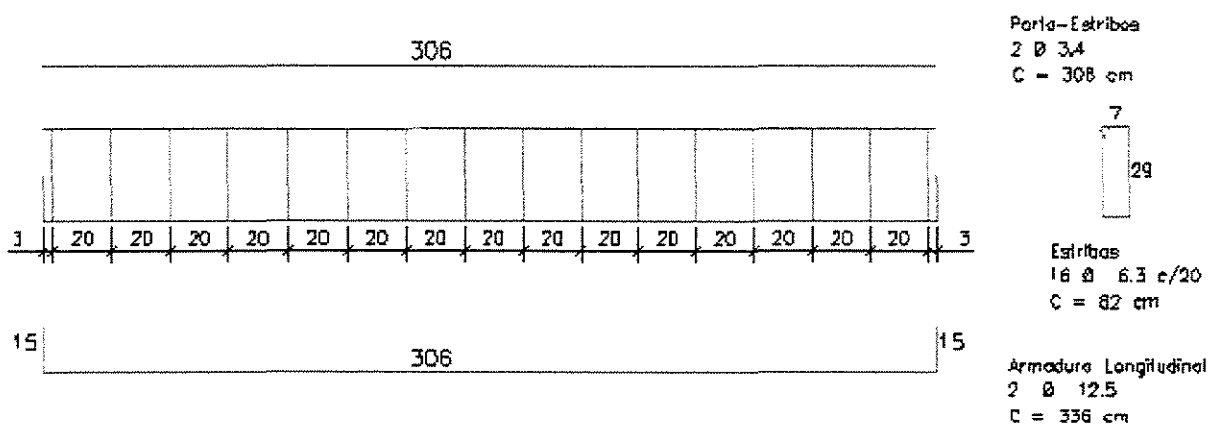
DETALHE DE ARMADURAS – VIGA 2BL-FL
